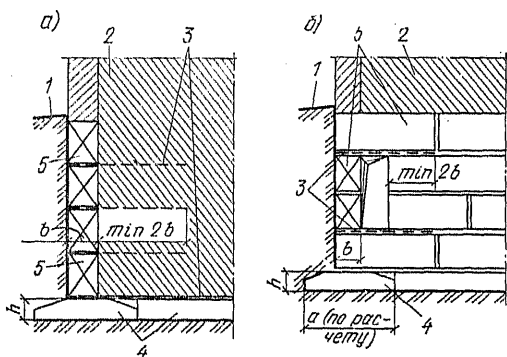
Примыкание кирпичной стены к стене из бетонных блоков (а) и устройство вводов (б)
